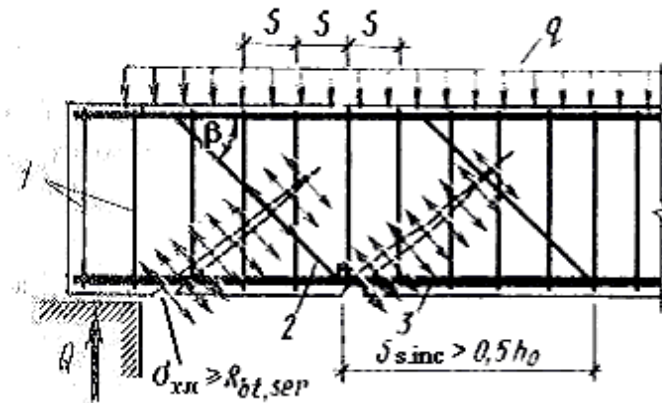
Схема утворення похилих тріщин: 1 – хомути, 2 – відгини, 3 – подовжня арматура
